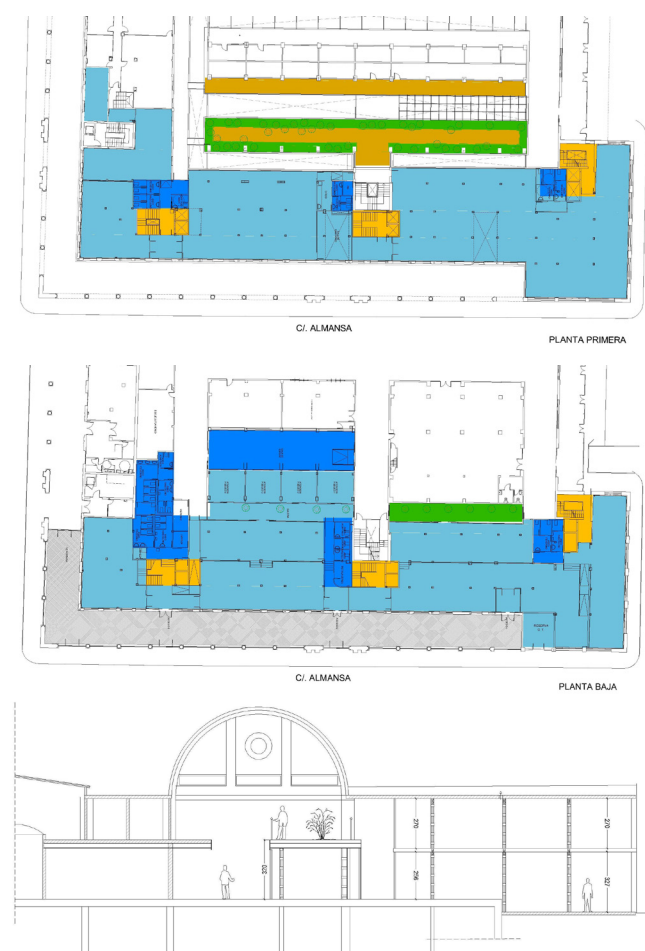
Plantas baja y primera de las Fases 1 y 2 y Sección.
